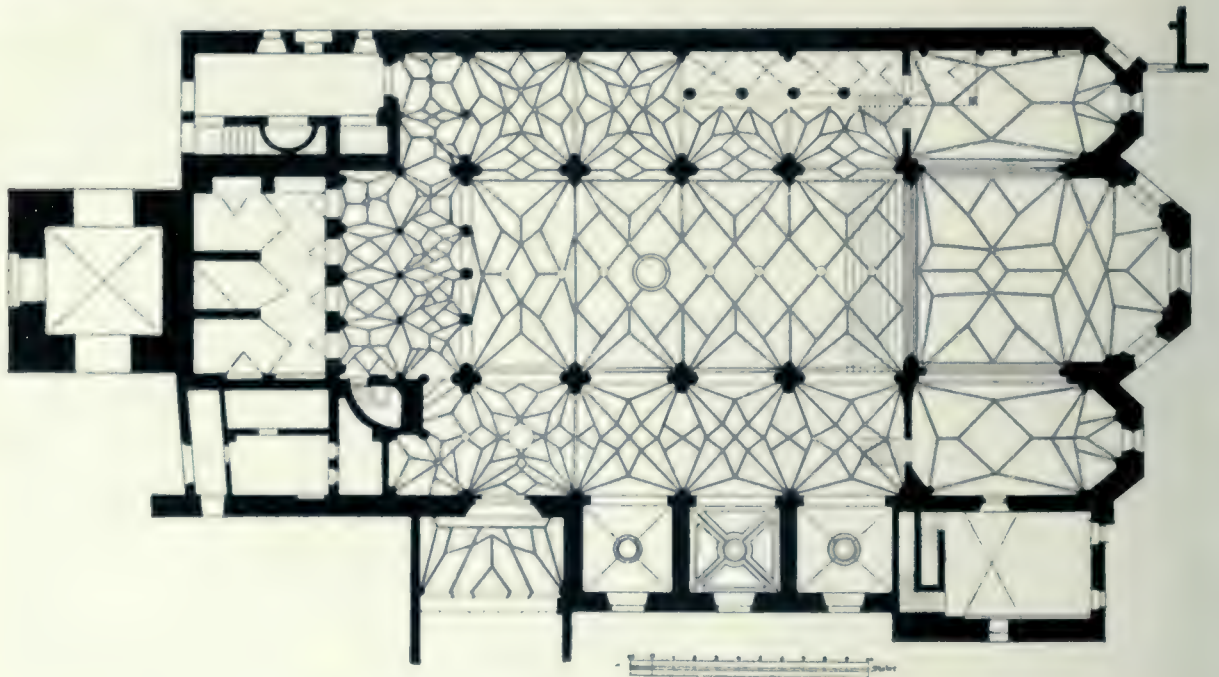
Stiftskirche, Grundriß 1:350 (S. 3)
